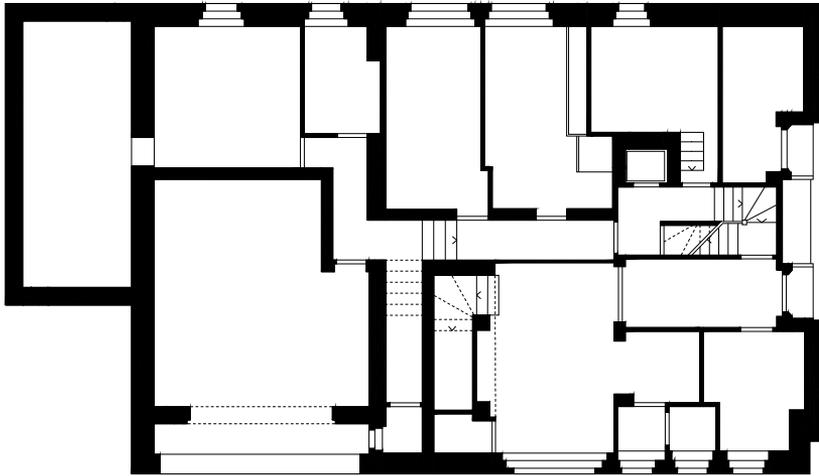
Villa Müller*. Planos delineados sobre la base de los planos originales de Adolf Loos (1928-1930) de la Colección Albertina, Viena.
